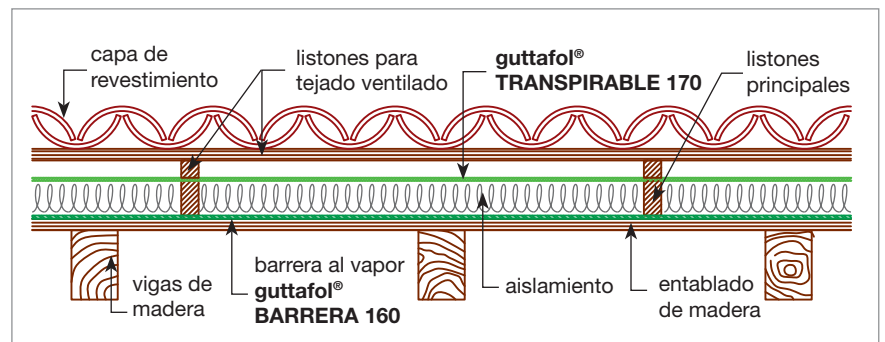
guttafol® TRANSPIRABLE 170 sobre el aislamiento con cámara de ventilación
